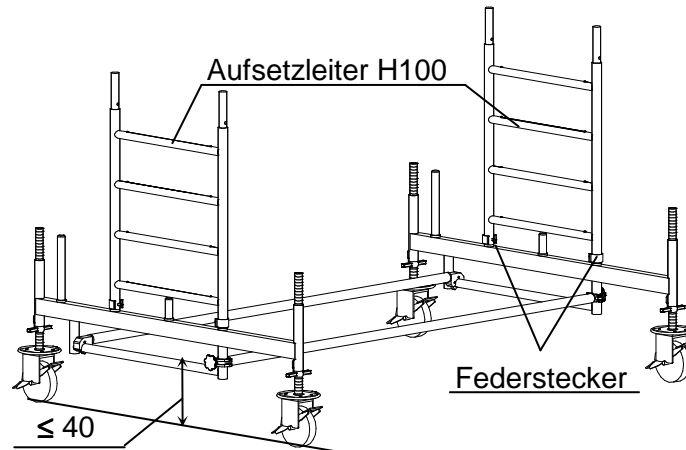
Grundeinheit mit Fahrbalken L180 – mittige Stellung
